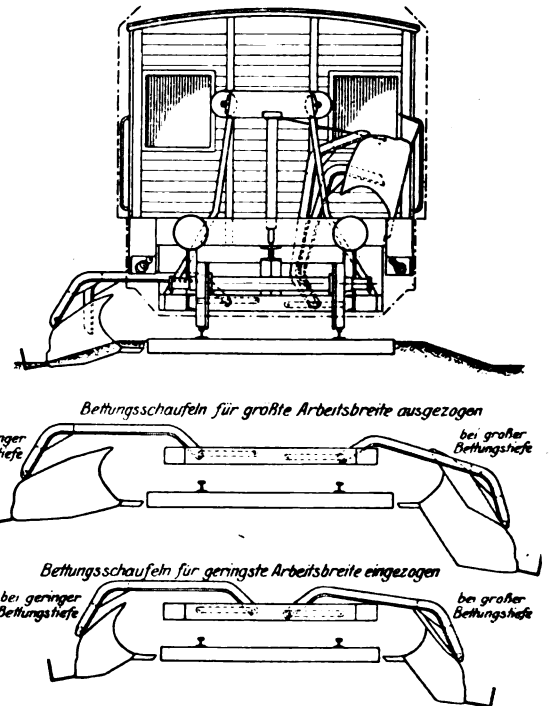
Endansicht und Einstellung der Bettungsschaufeln in verschiedenen Arbeitslagen
